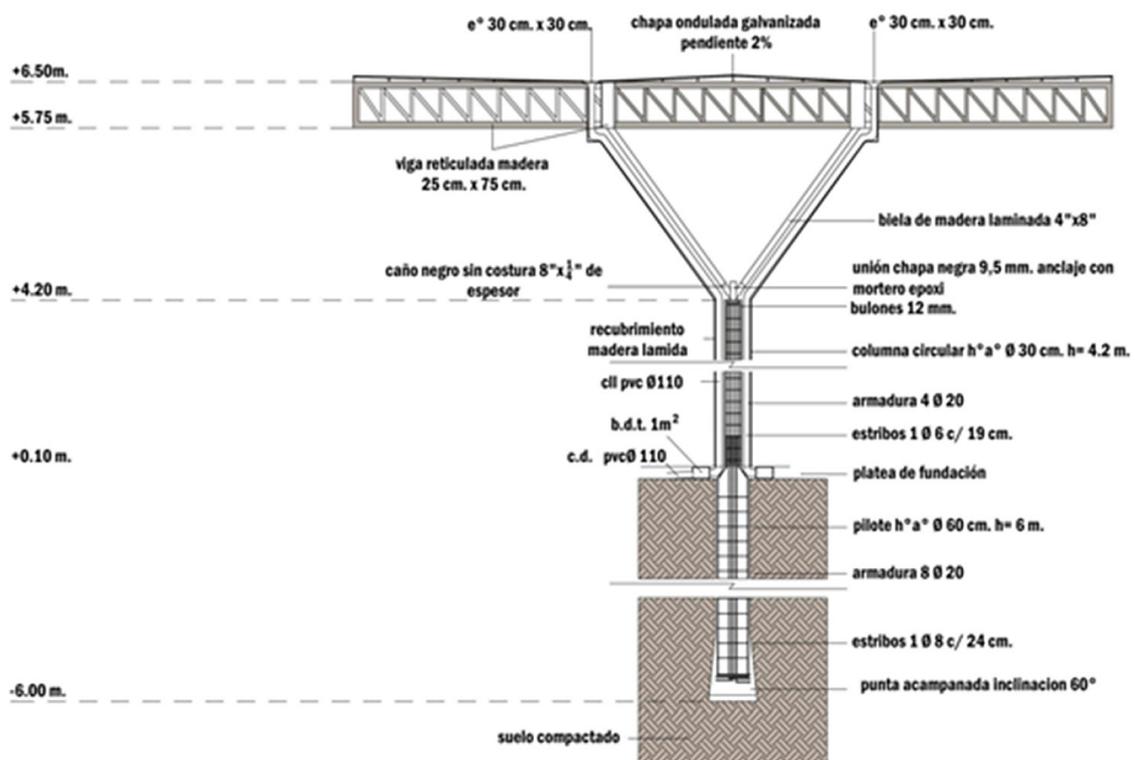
Detalle de columna sobretecho. Fuente: elaboración propia
